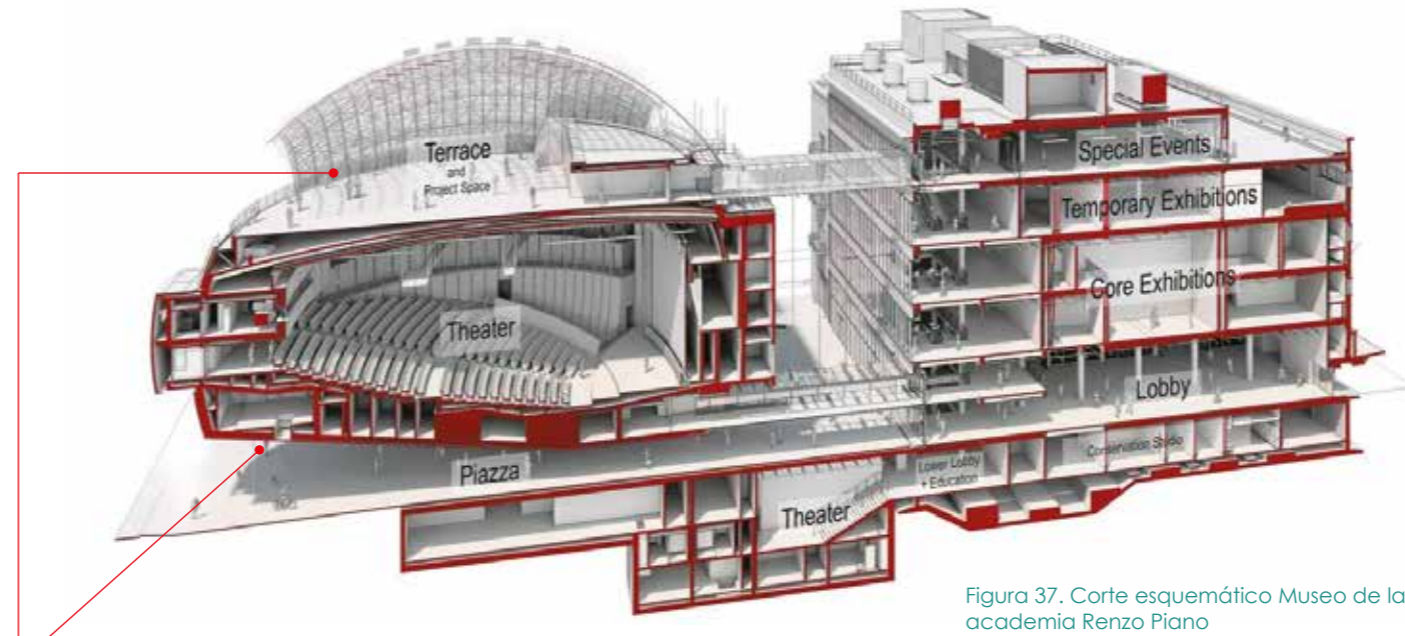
Corte esquemático Museo de la academia Renzo Piano
